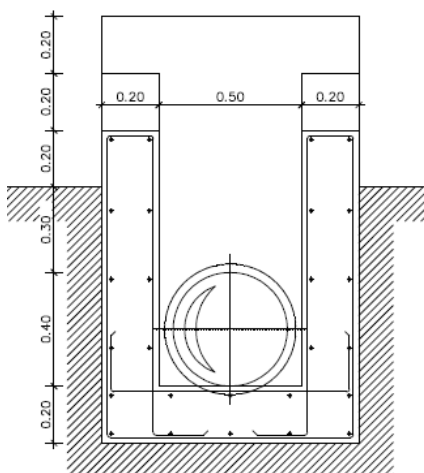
Corte AB do aqueduto em manilhas de betão com 400mm de diâmetro (cotas em metros).
